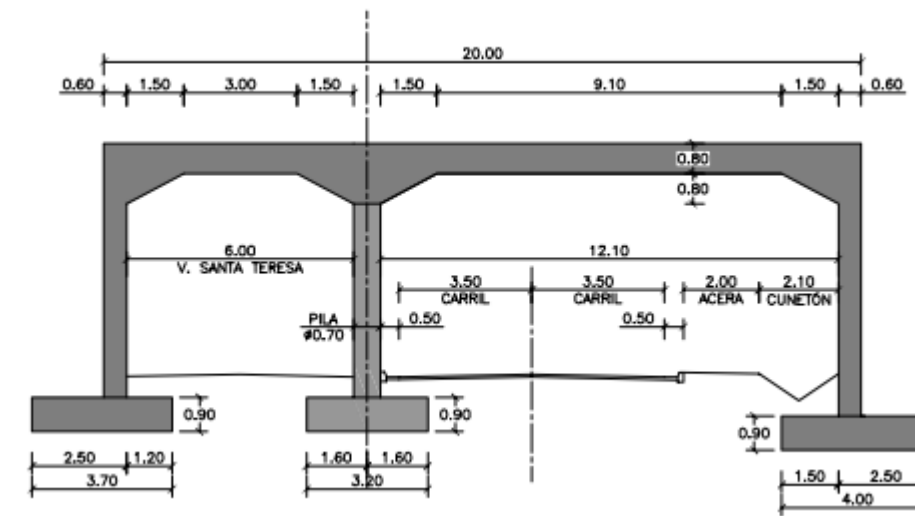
SECCIÓN TIPO PI ACCESO ESTACIÓN DE ELCHE Y COLADA DE SANTA TERESA P.K. 2+990
